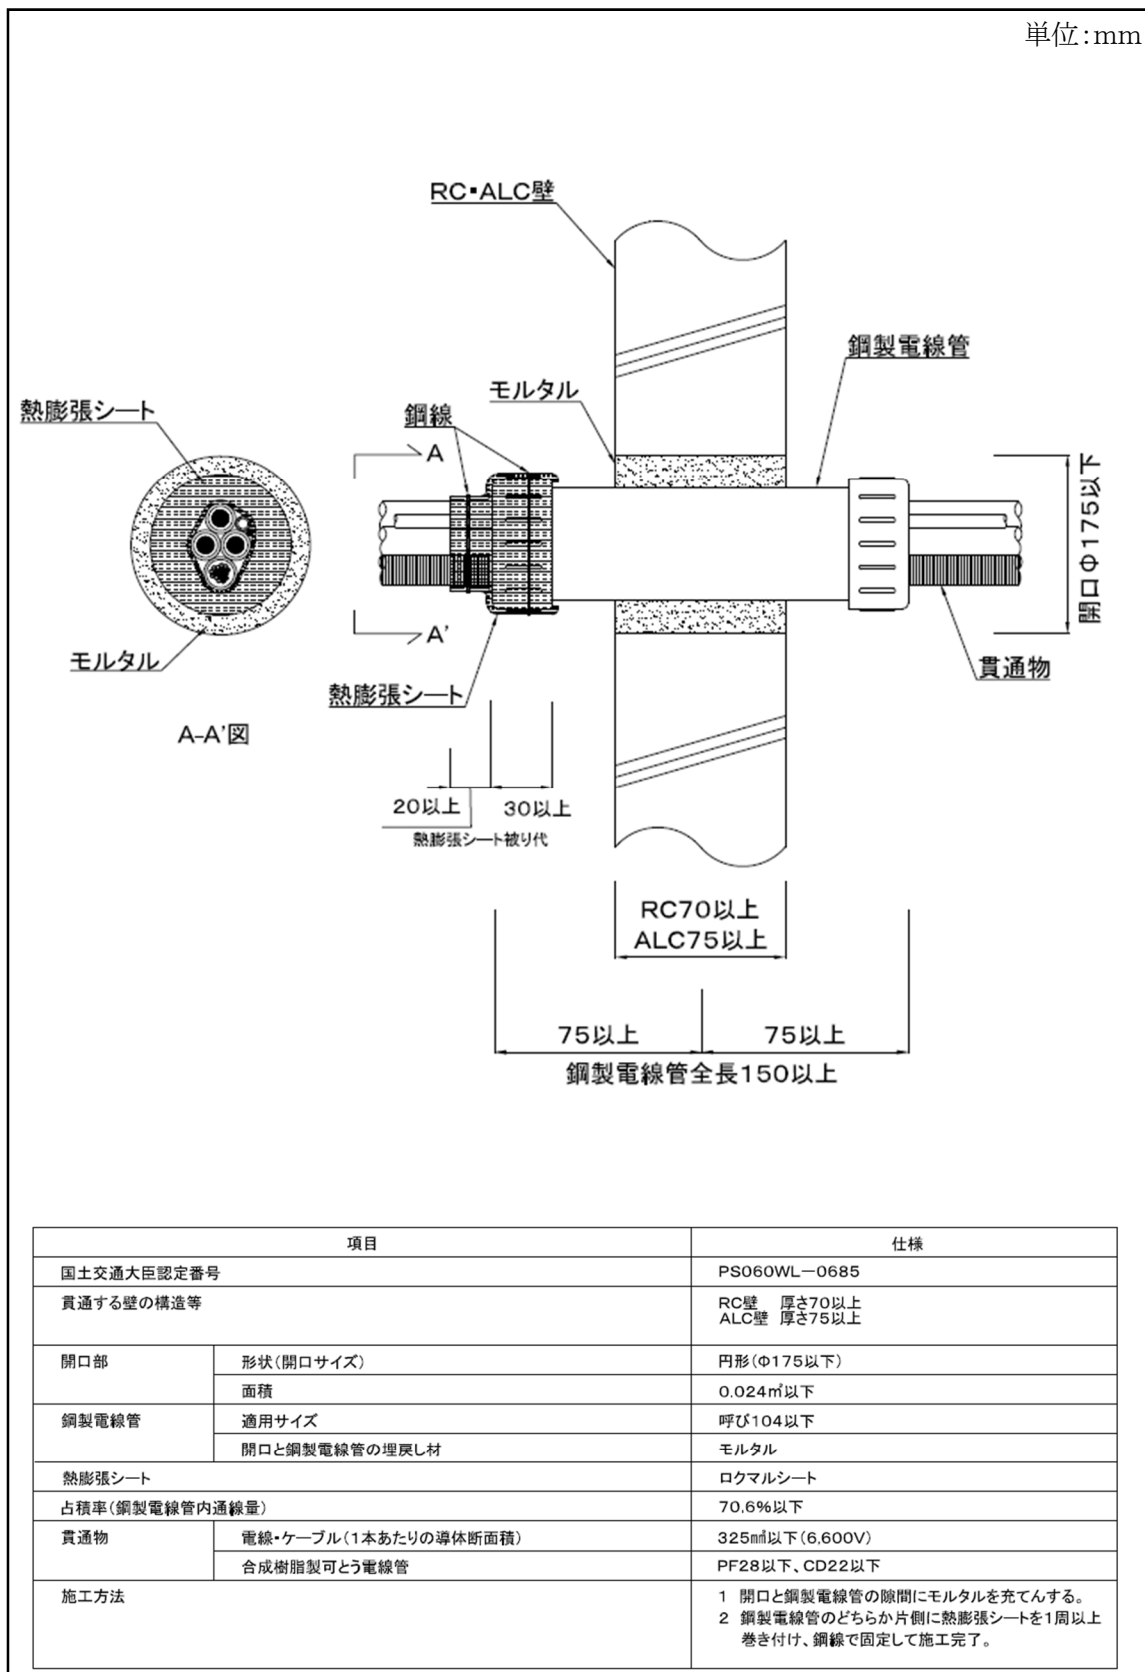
鉄筋コンクリート・ALC 壁(PS060WL-0685) 標準施工図
